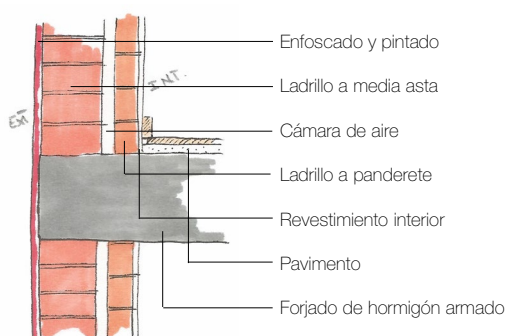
Encuentro pared de fachada con forjado (autoría propia).
